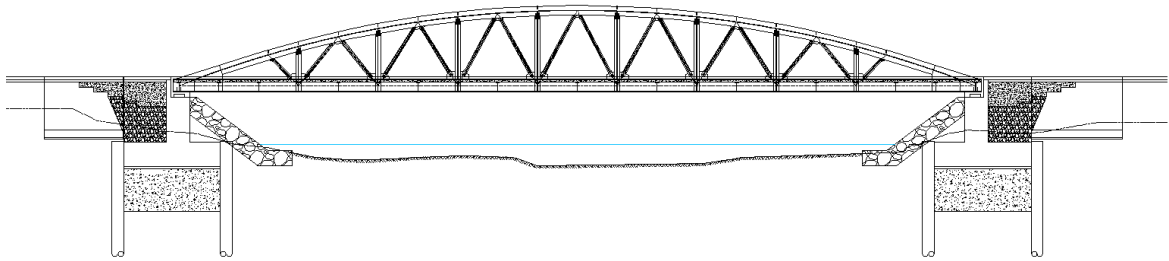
Ponte sulla Dora_Sezione longitudinale
